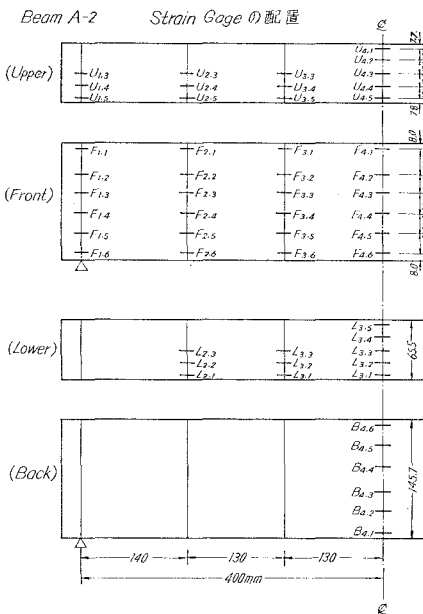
鋼箱桁模型 Beam A-2 のゲージの位置
